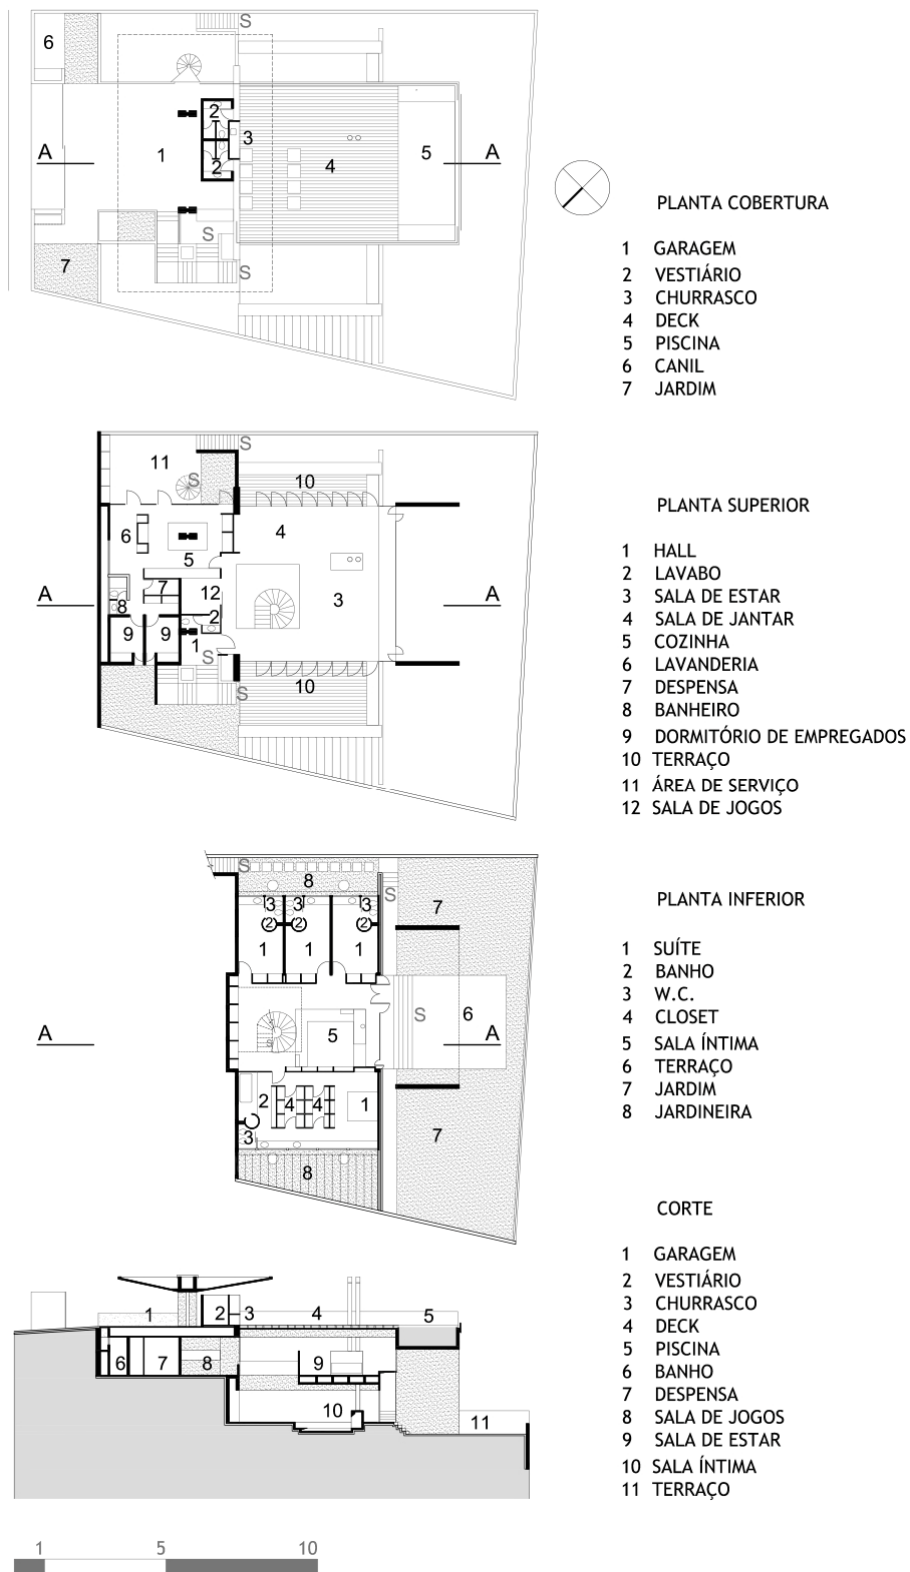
Plantas da cobertura, do pavimento superior, do inferior e corte. Fonte: autora.
